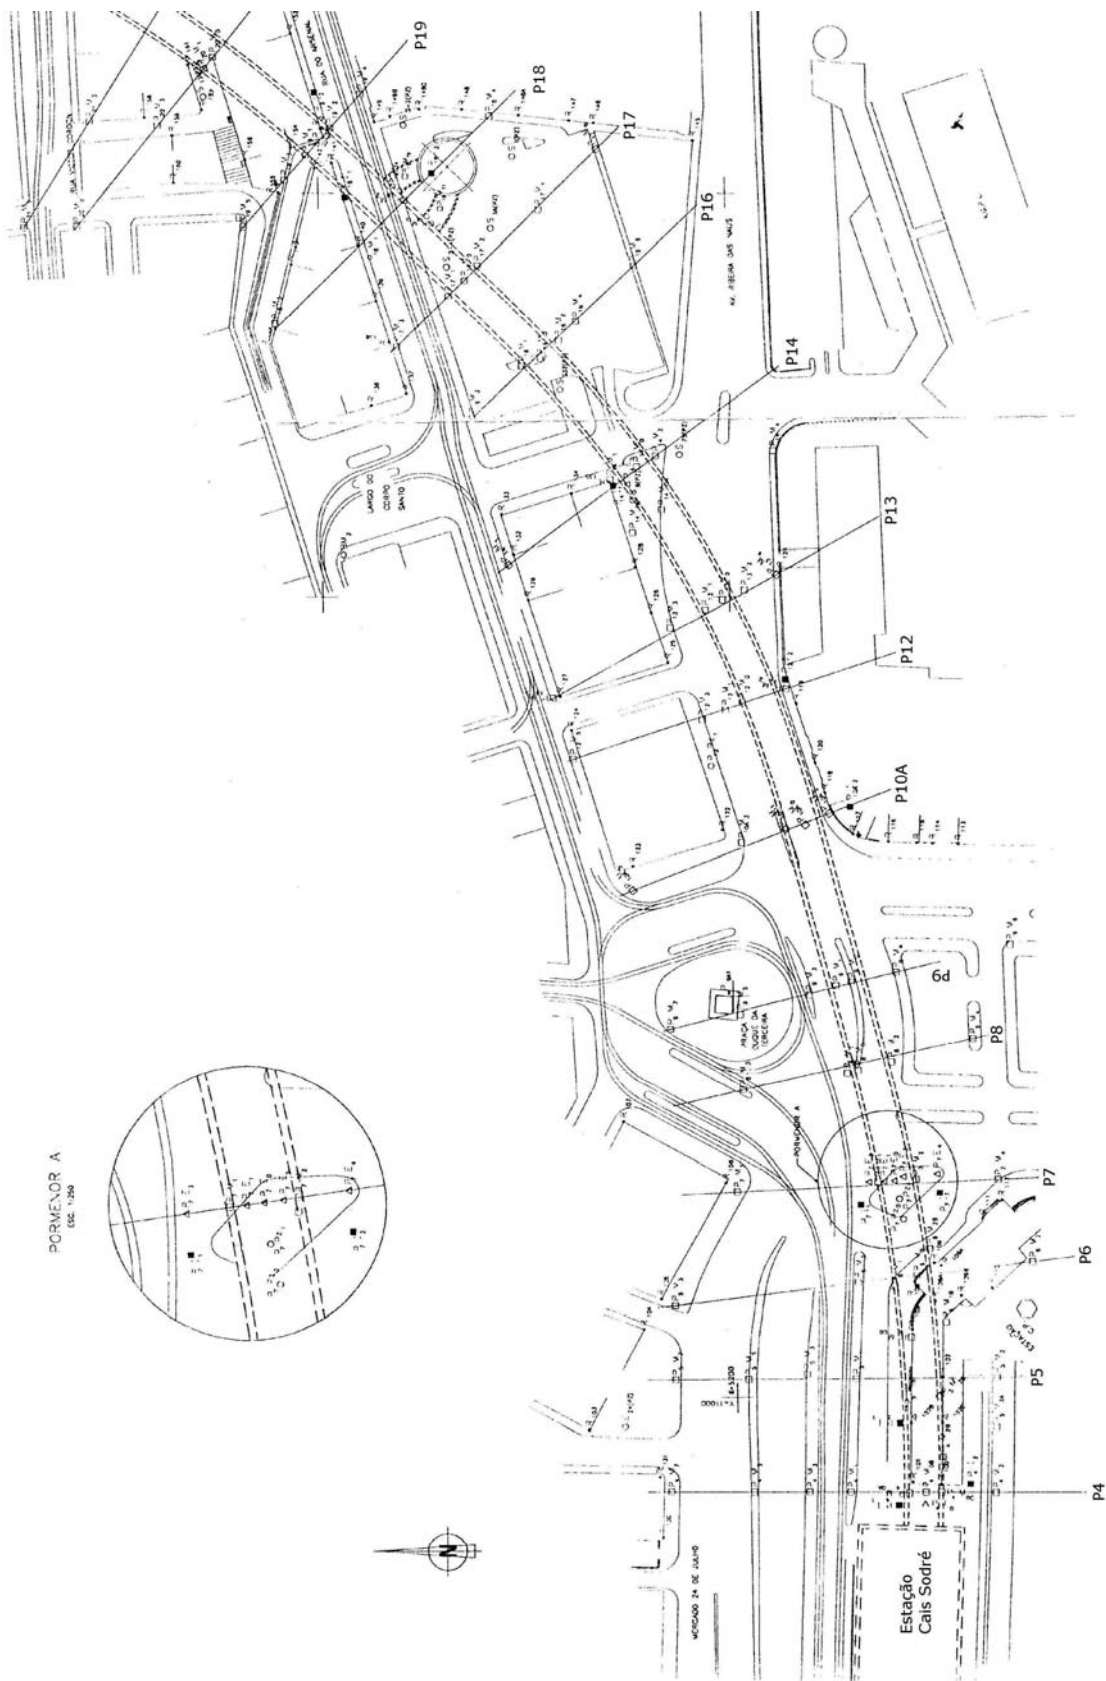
Planta de localização da instrumentação do troço 63 – Cais do Sodré – Baixa/Chiado.
